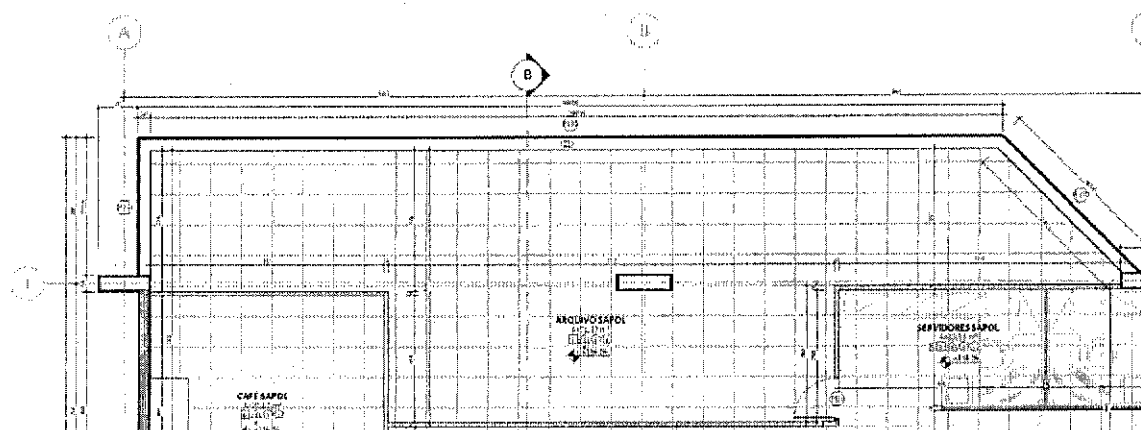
planta do 3º pavimento da obra DRF Bauru (CAT 2620180009585), área de arquivo SAPOL com 71,33m². Obra de Construção.
